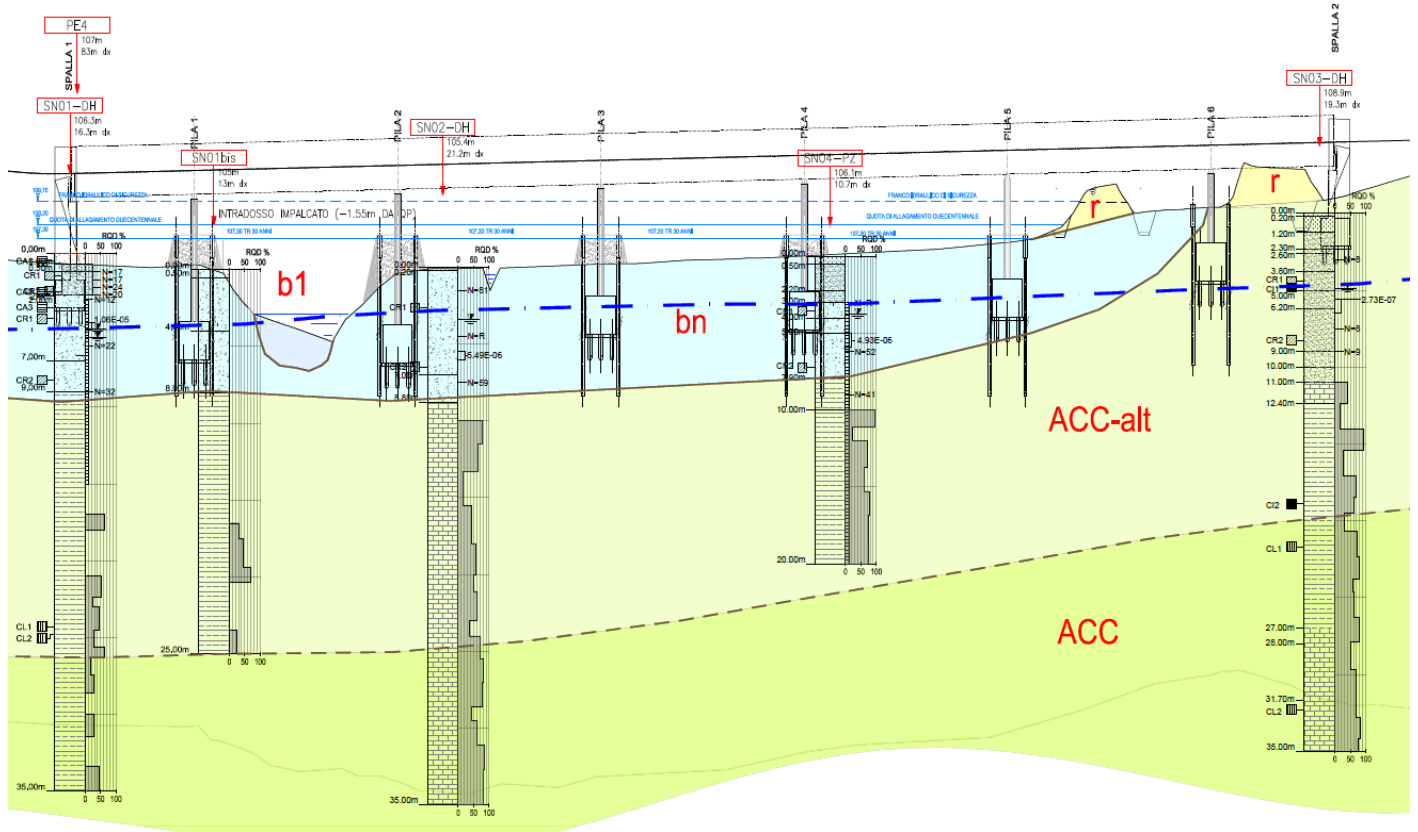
Stralcio profilo geotecnico Viadotto Sieve 1
